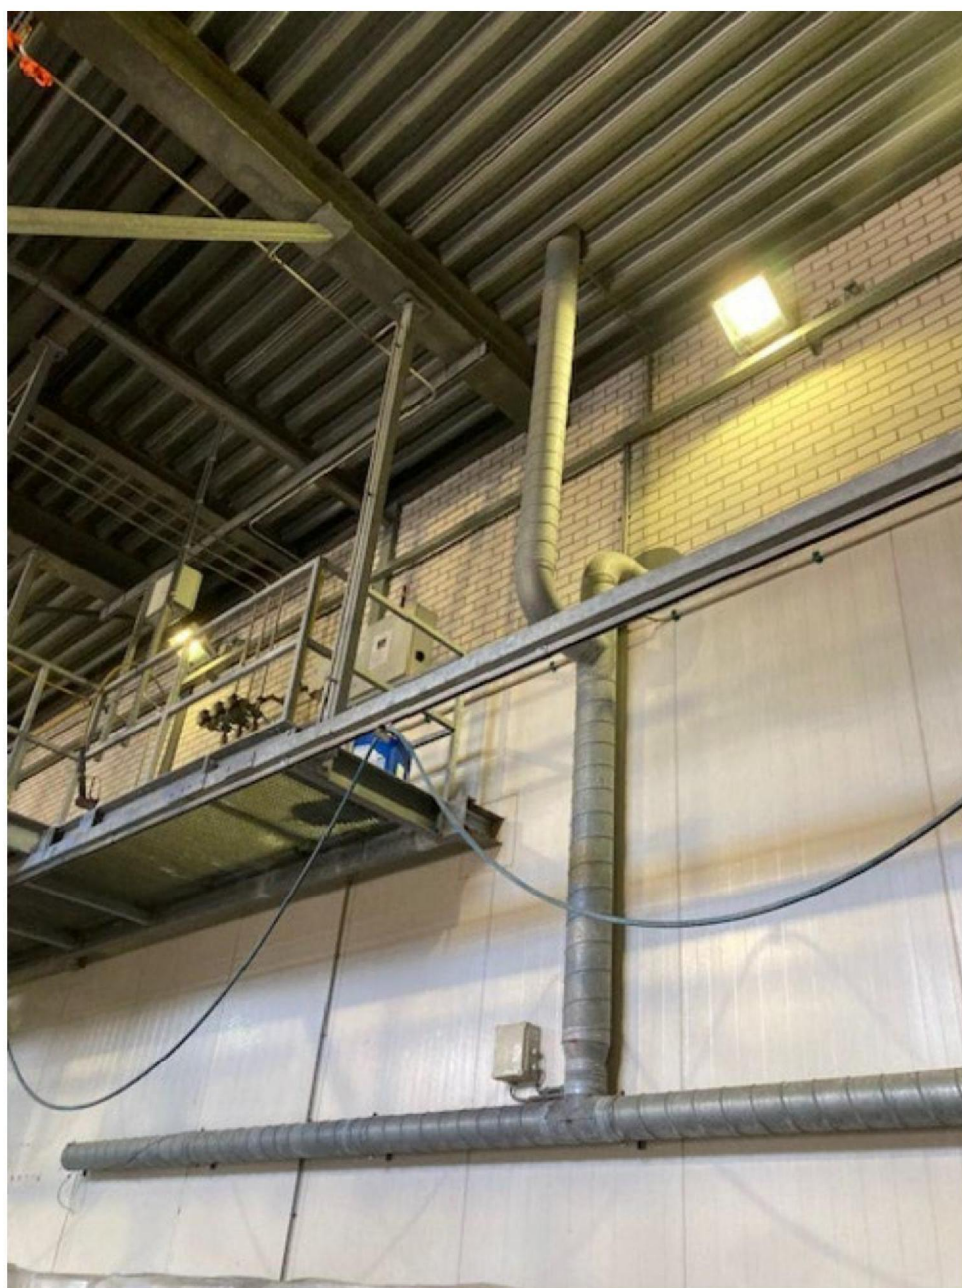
Afzuiging silohal voor emissies van voertuigen af te voeren bij draaiende motor uit hal. Aansluiting vindt plaats op installatie zichtbaar op foto's 15 en 16
